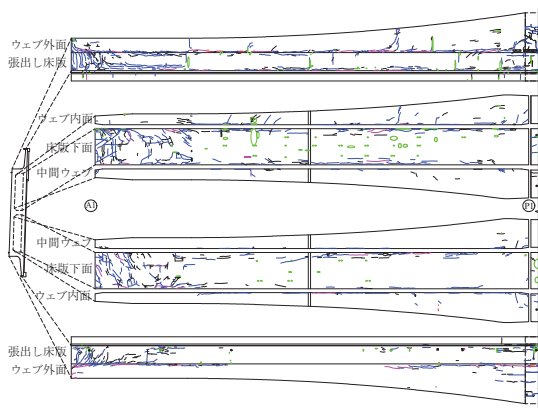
PC 箱桁部（A1-P1 間）のひび割れ状況
